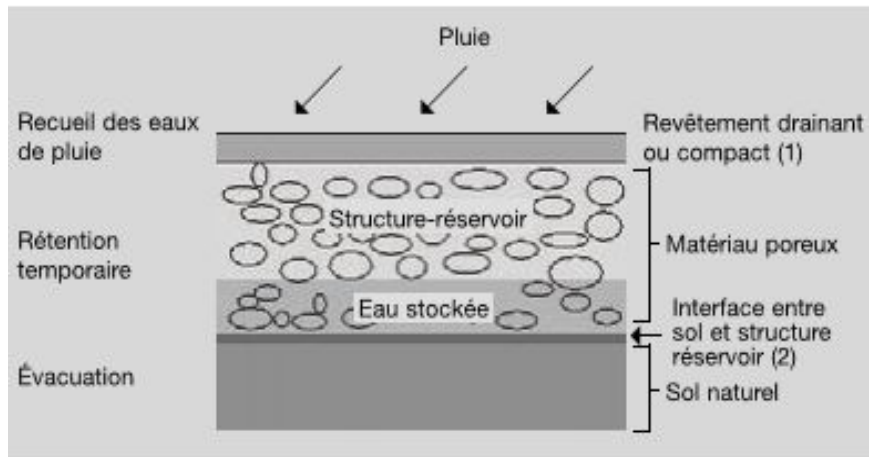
Mise en évidence de la structure d'une chaussée réservoir
